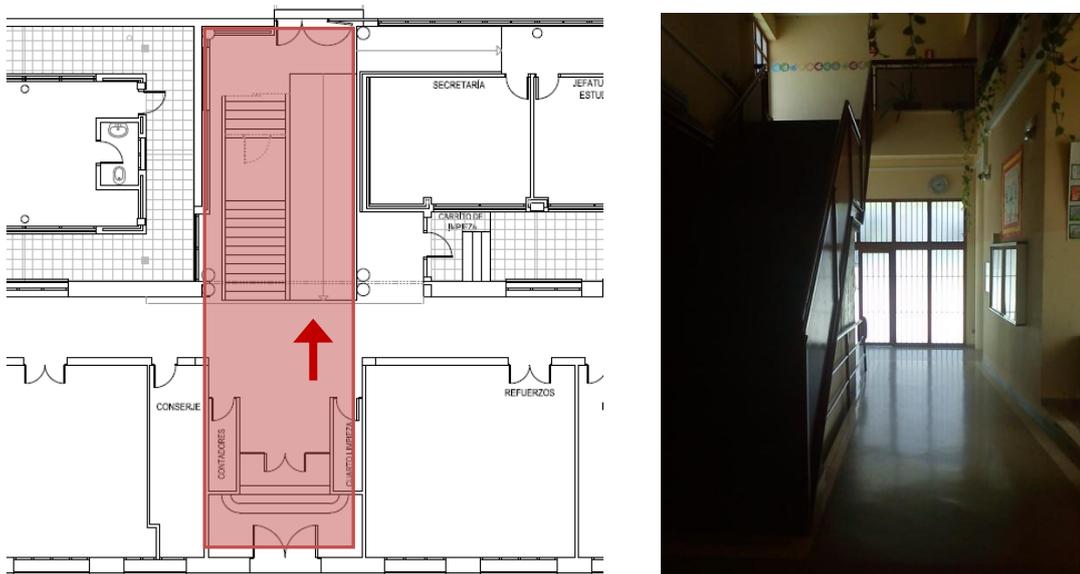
Situación y vista del pasillo Sur de P.B. (foto autor)
